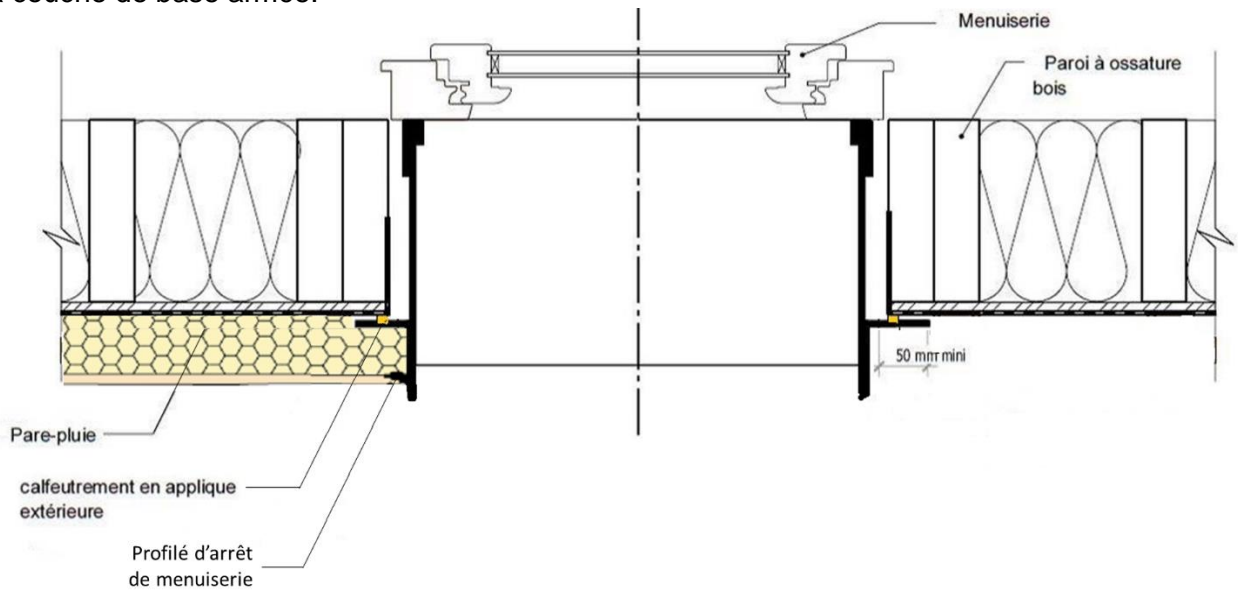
Encadrement de baie rapporté (Ee2) – coupe horizontale
